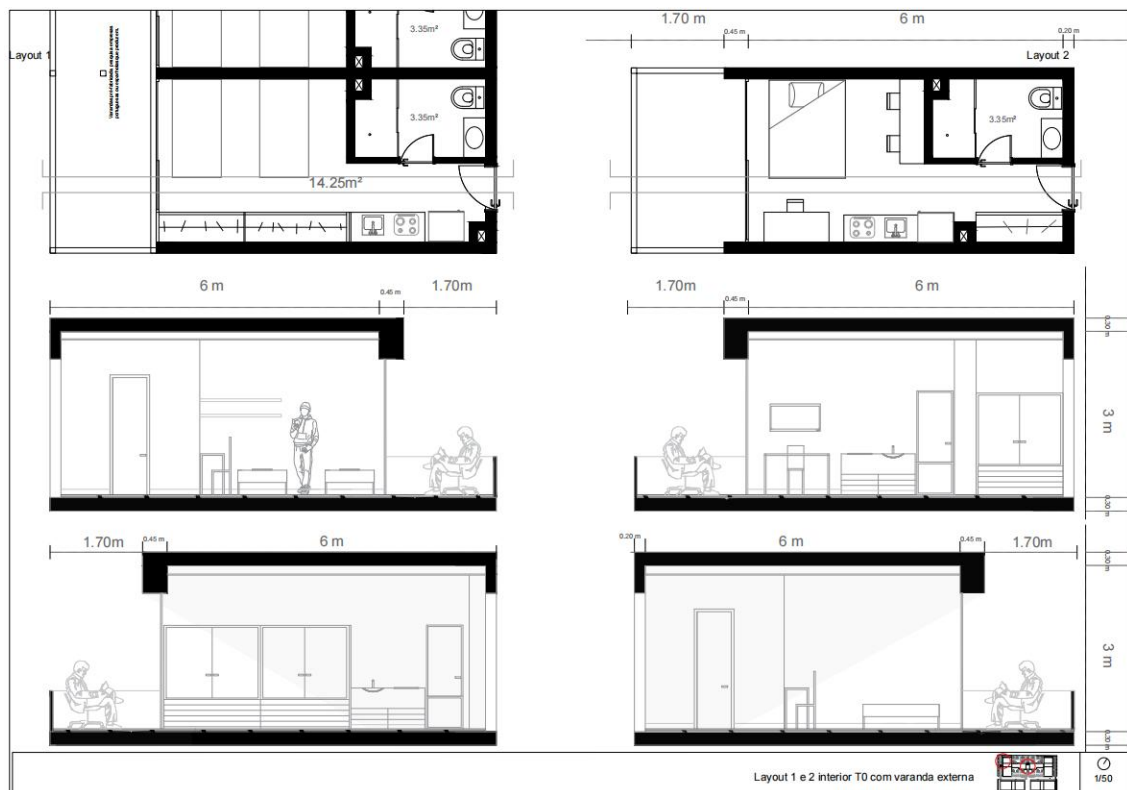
Planta do Layouts 1 e 2 das Unidades 1/50.
